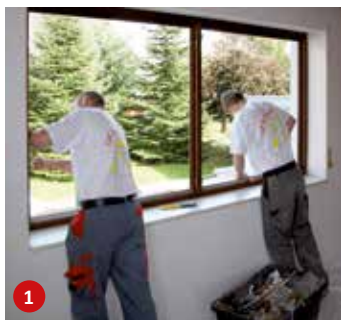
5: Der alte Holzrahmen wird mit speziellem Werkzeug fachmännisch und sauber entfernt
